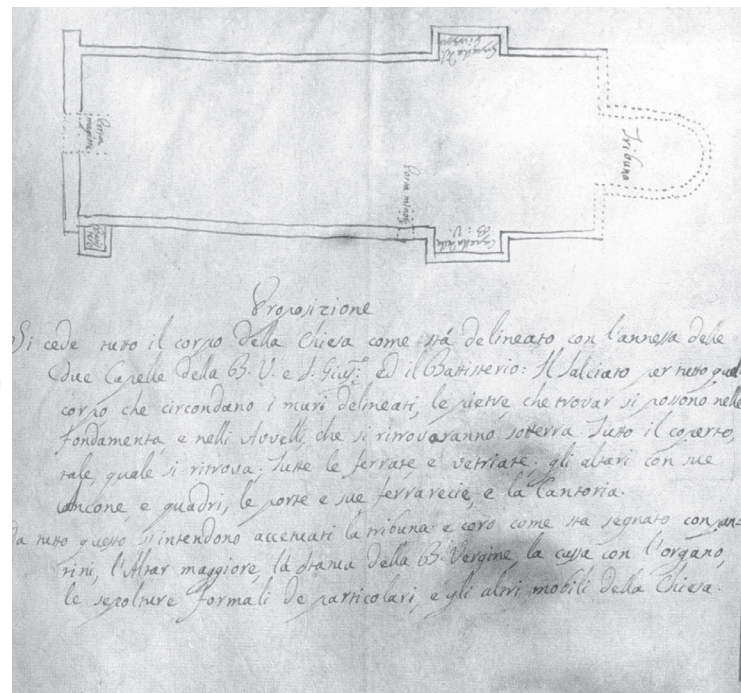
RAVALLE, ARCHIVIO PARROCCHIALE, DISEGNO PERIMETRALE DELLA VECCHIA CHIESA, 1785
